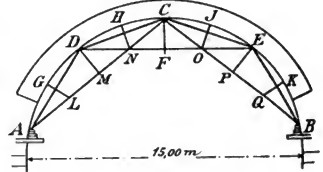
Lehrgerüst mit Trapez- und Dreieckhängewerken.
